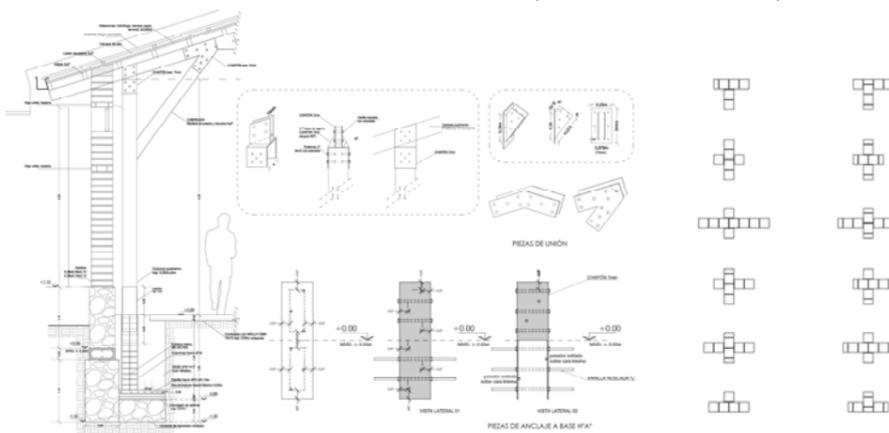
Detalles constructivos y combinaciones entre adobes (Fuente: dibujos de los autores)
